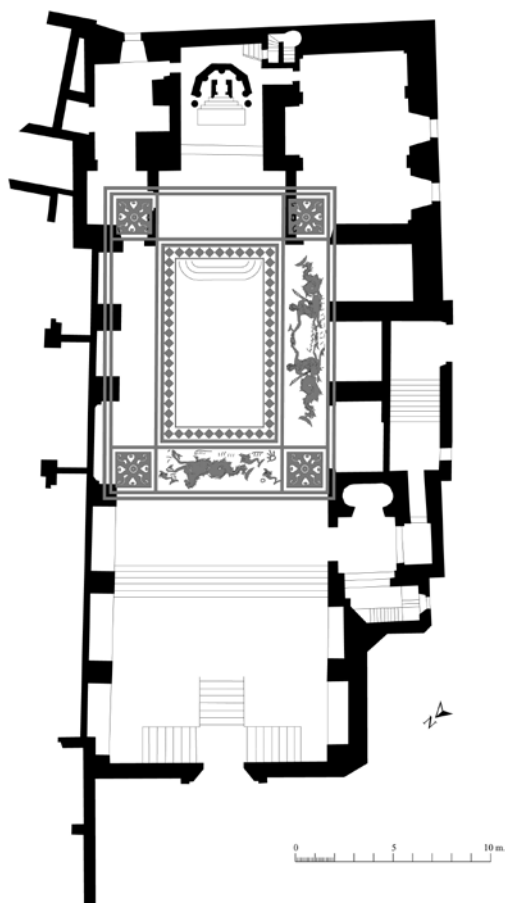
Planta de la iglesia de Sant Miquel con la situación del mosaico de las termas romanas usado como pavimento. Planimetría: E. Revilla-MHCB
